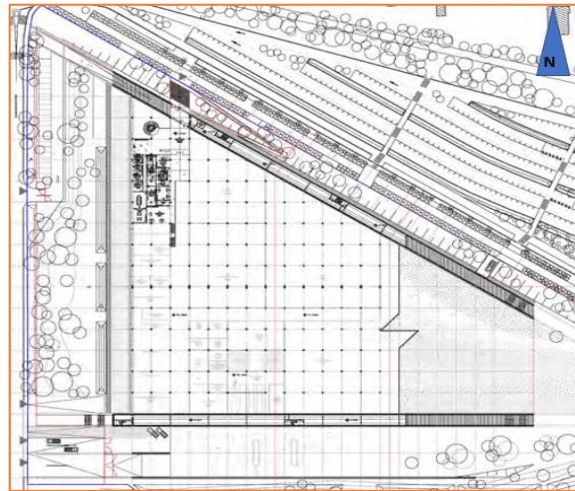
Plan de 1^{er} étage de centre Louvre Liévin.
